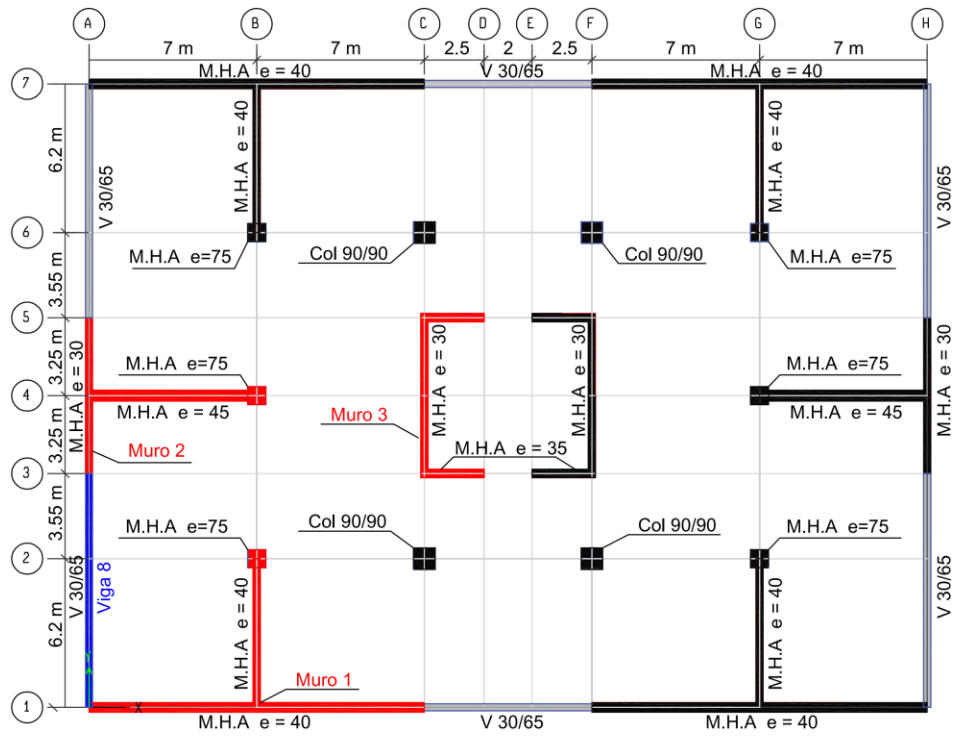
Planta pisos 1 a 5, elementos estructurales definidos.
